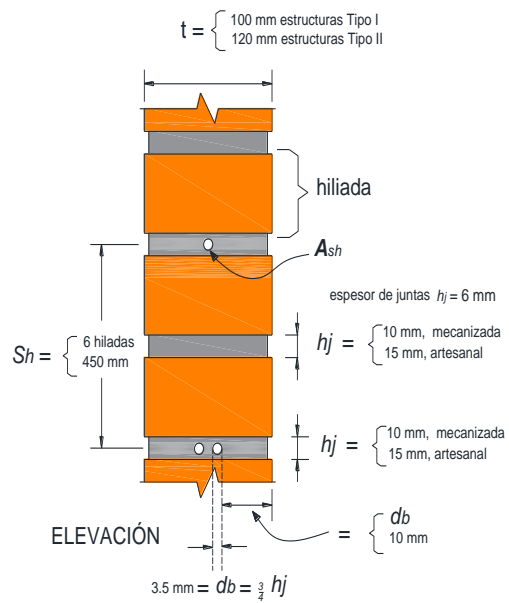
Detalle en elevación del refuerzo horizontal, fuente: NTC CDMX 2017. Elaboración propia
